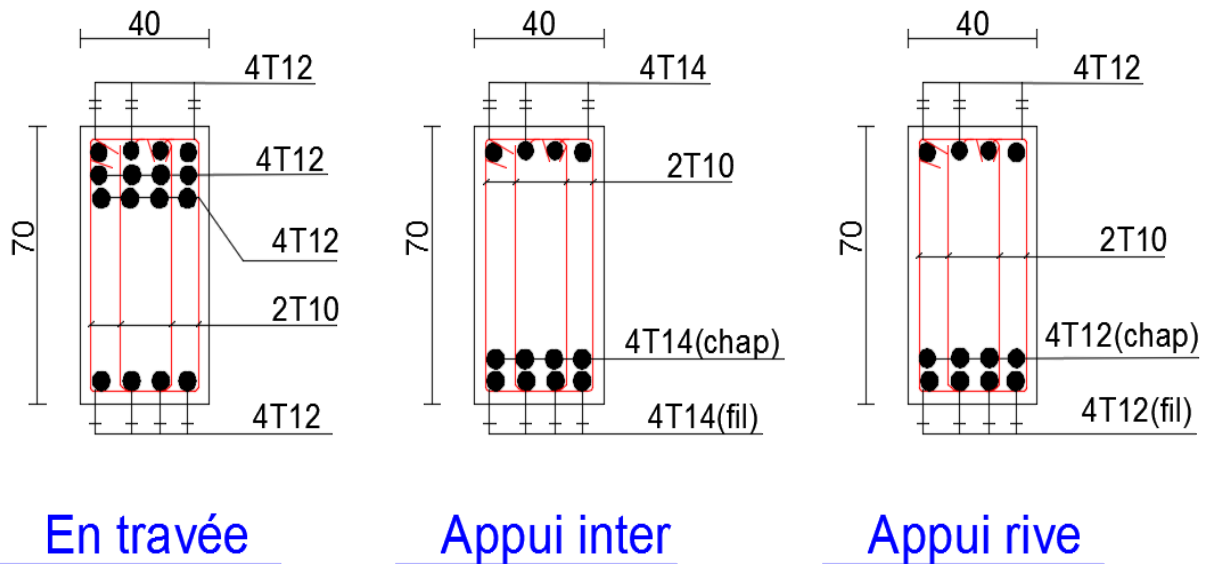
Ferrailage de la poutre de libage suivant le sens transversale.
